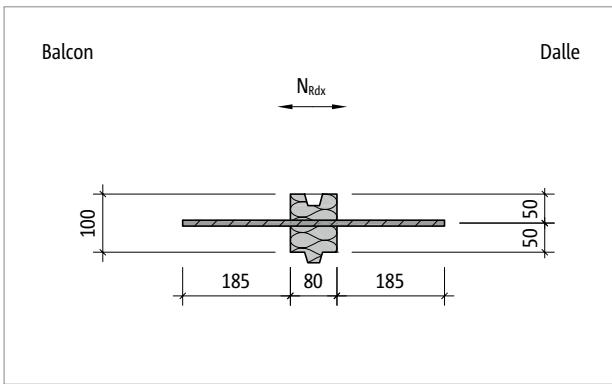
Schöck Isokorb® T Type H-NN1 : Plan de base du produit
